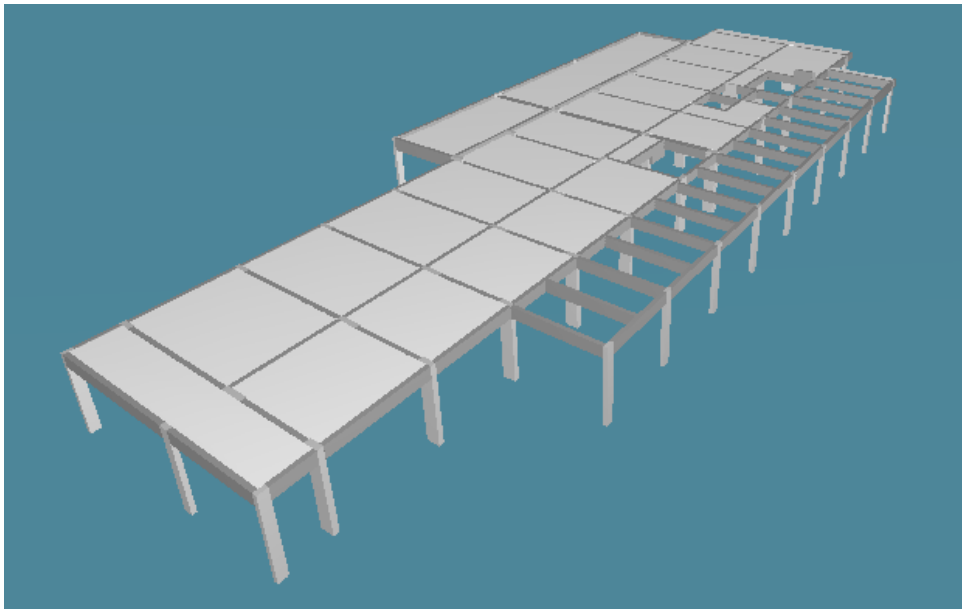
Modelo 3D do 2º pavimento lançado no TQS. (Fonte: Autor, 2023)
